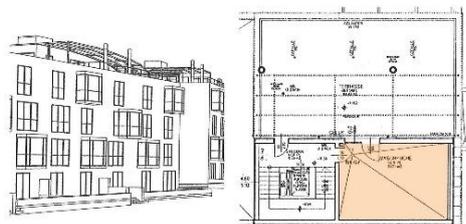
Waschküchen und Dachterrassen, Bauteil Arch. Prochazka, Dachgeschoss
